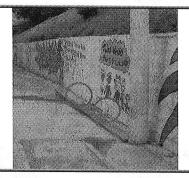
Drenajes para el manejo del drenaje subsuperficial dispuestos hacia la parte baja del muro de contención ubicado en la parte baja (pata) de la ladera evaluada.
